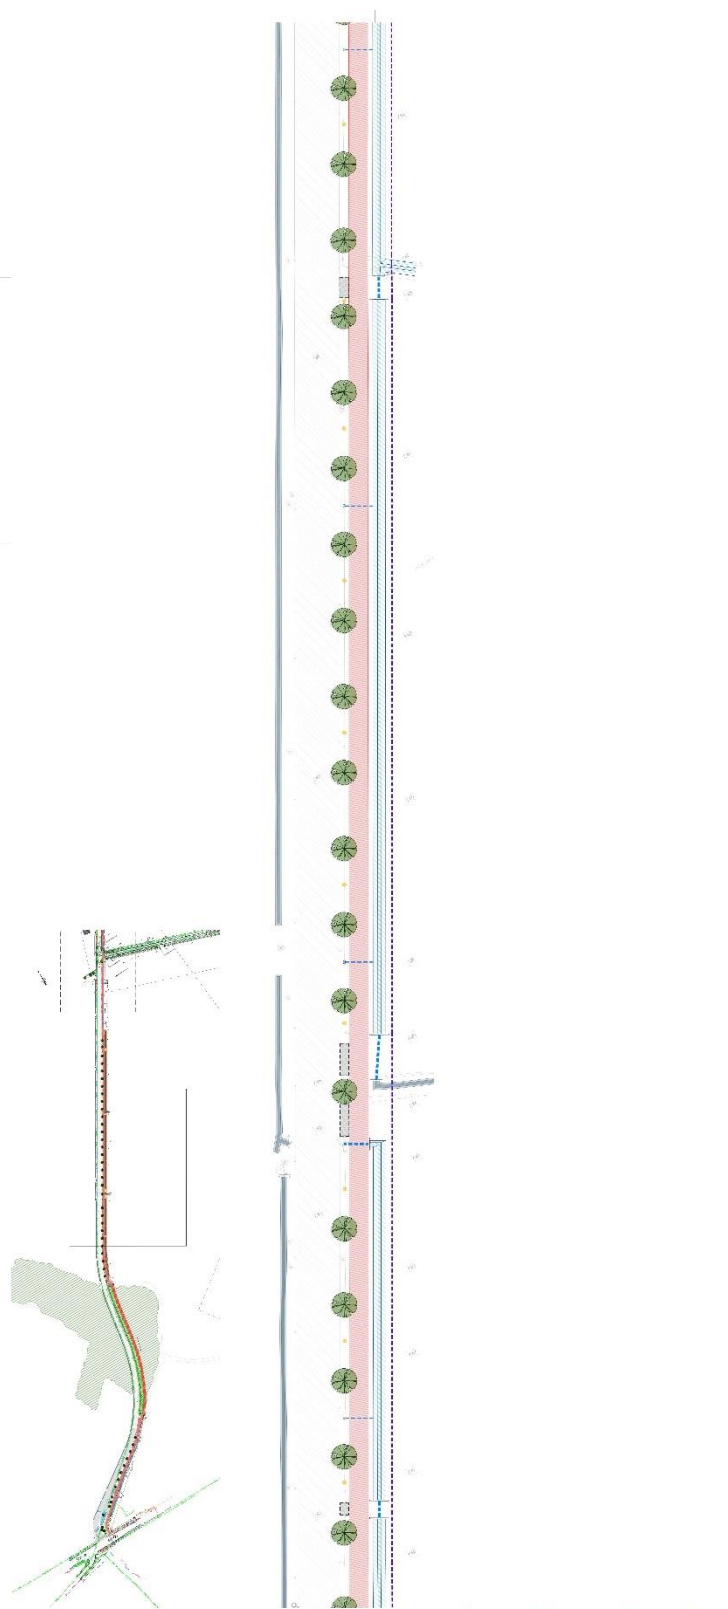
Toekomstige inplanting, detail 1 (noord)⁹
